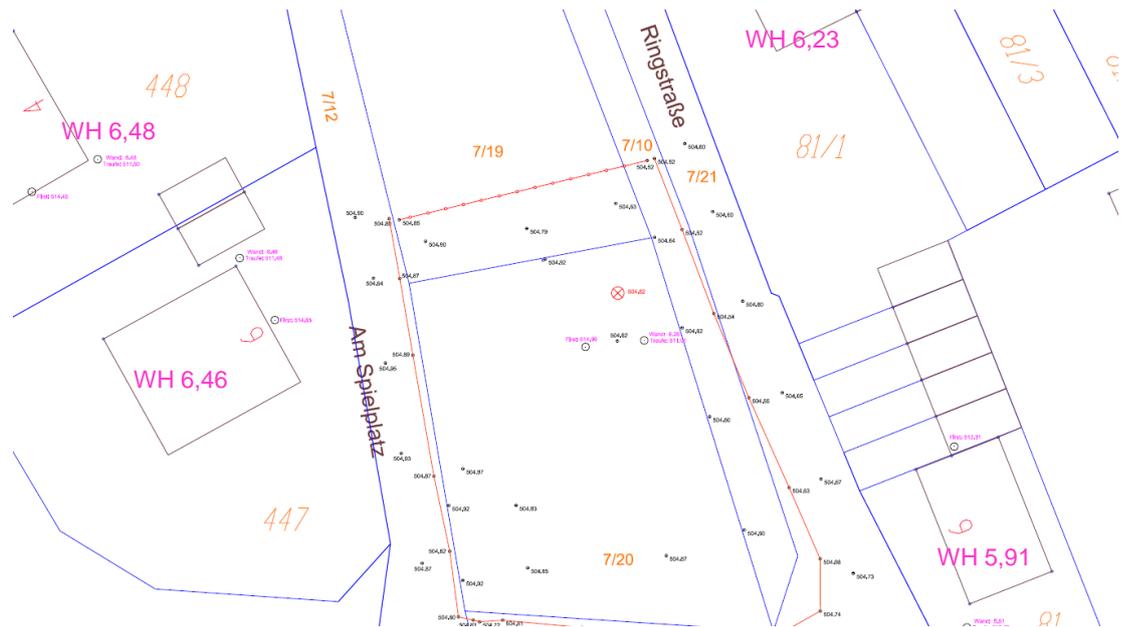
Ausschnitt Vermessungsplan für Grundstück 7/20 und Umgebung, ohne Maßstab
